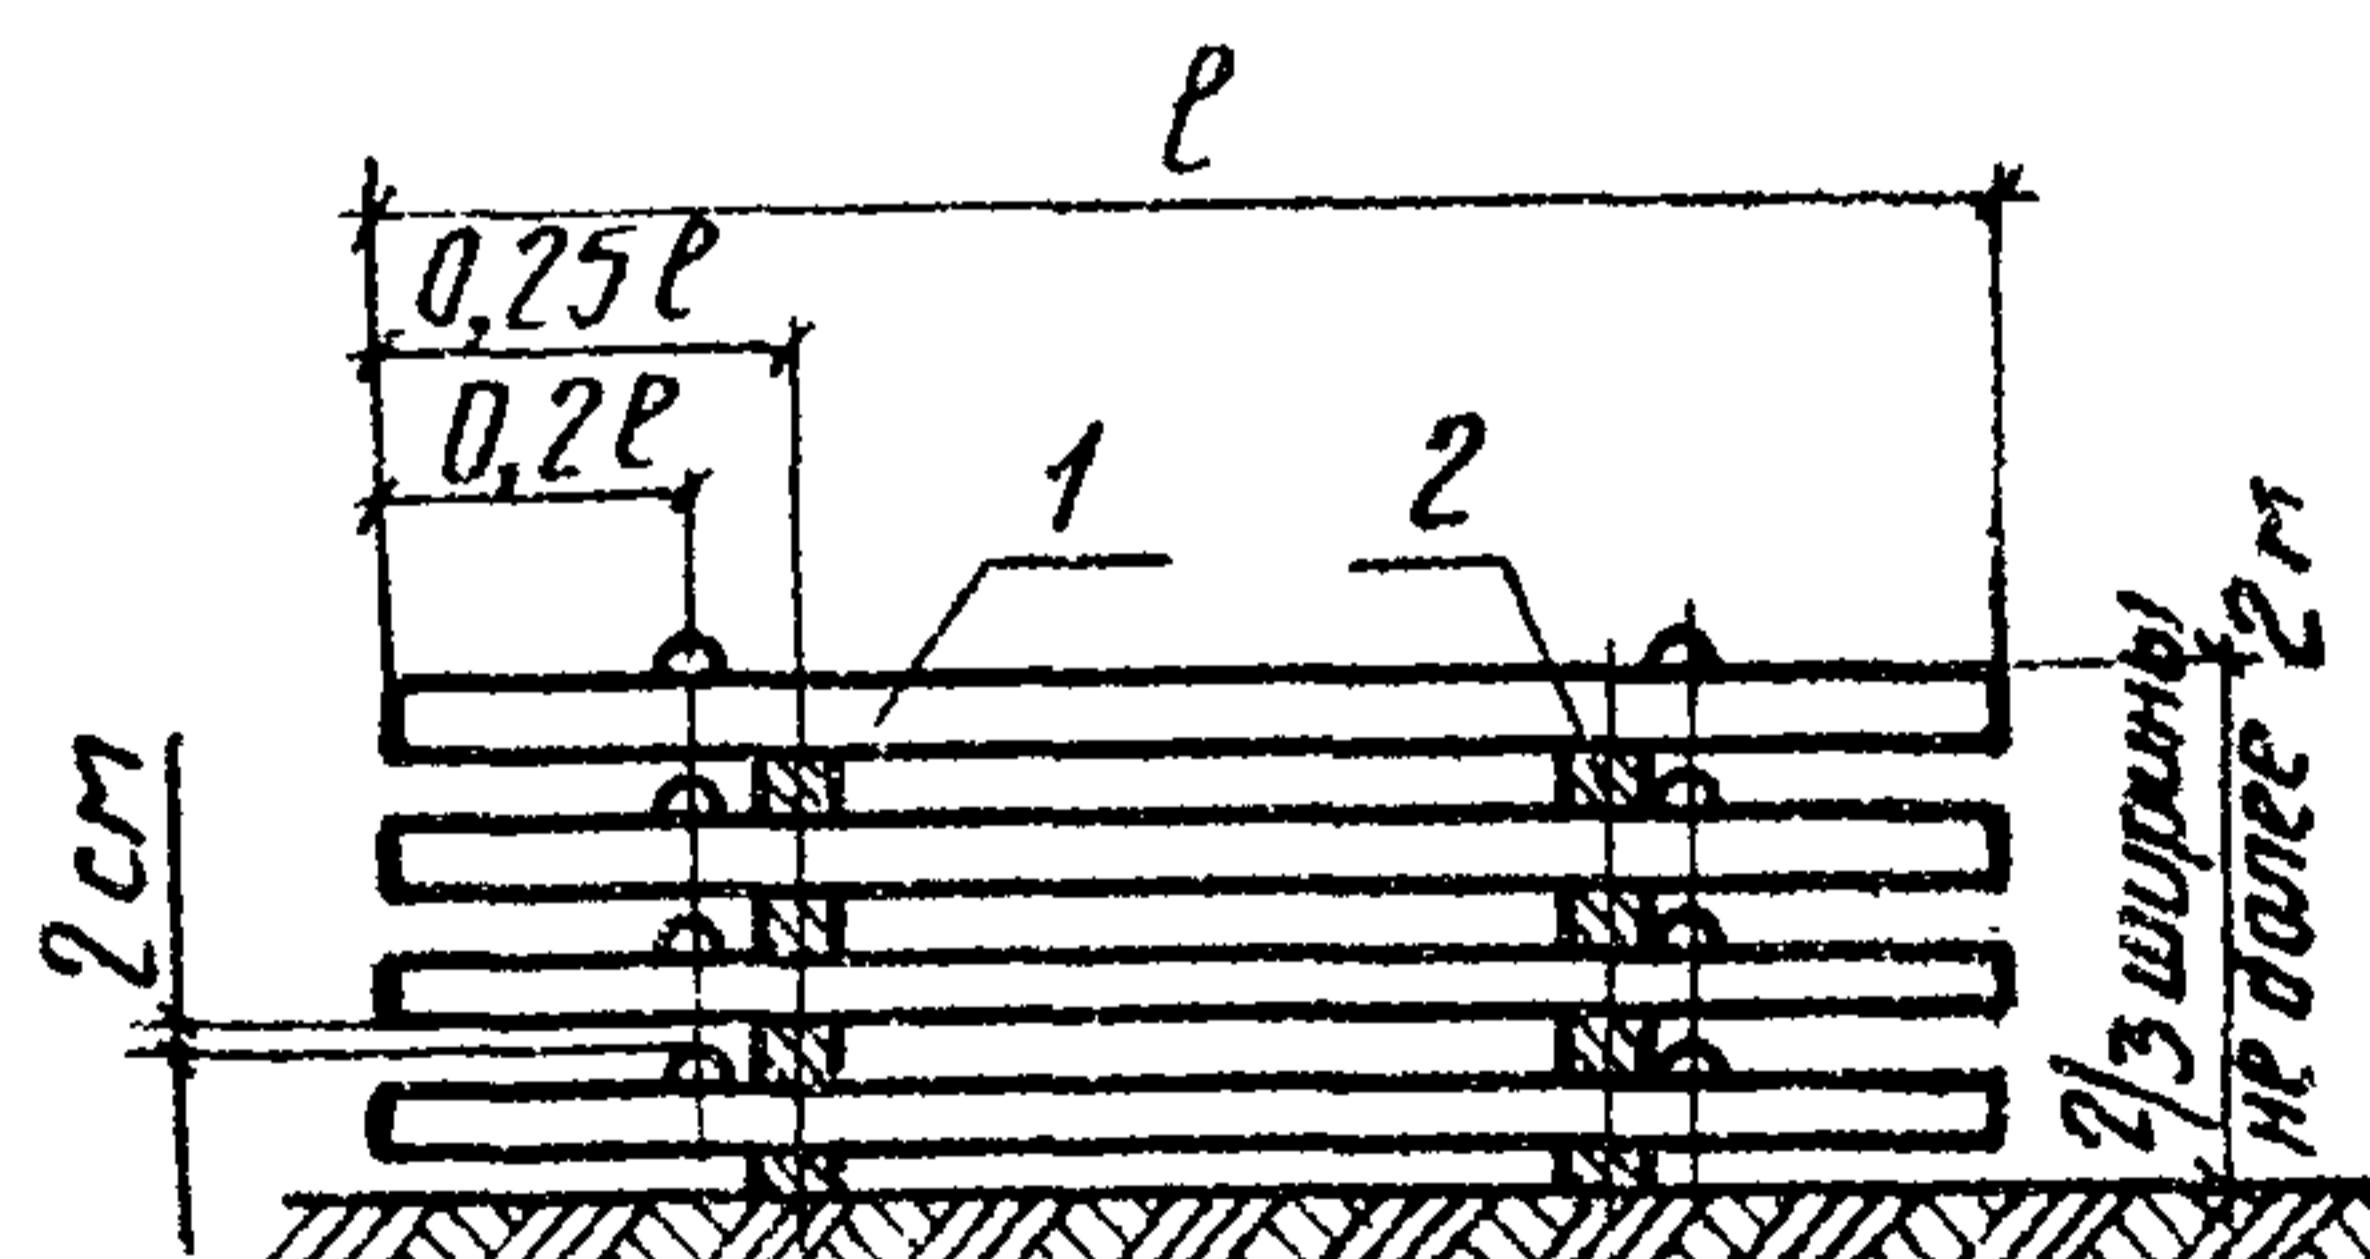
Схема укладки свай в штабель: 1-сваи; 2-деревянные прокладки из бруса 100x100 мм
